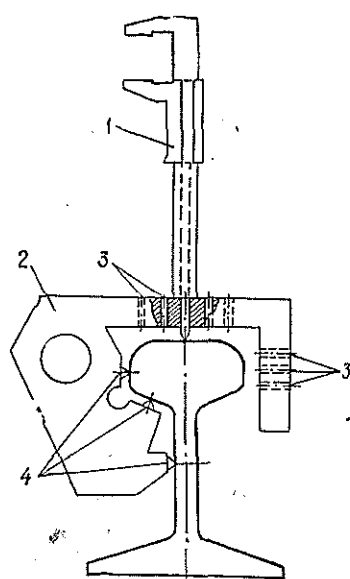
Шаблон-профилемер: 1 — штангенциркуль; 2 — шаблон; 3 — отверстия; 4 — базовые точки
